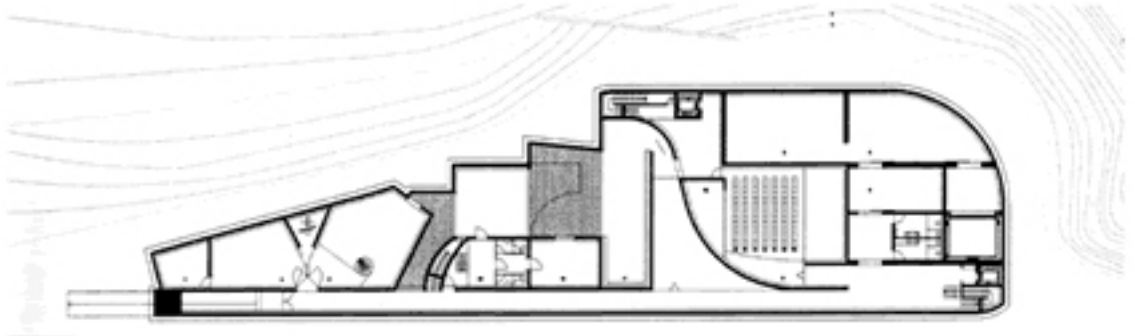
Planta baixa do térreo do Museu Iberê Camargo.
